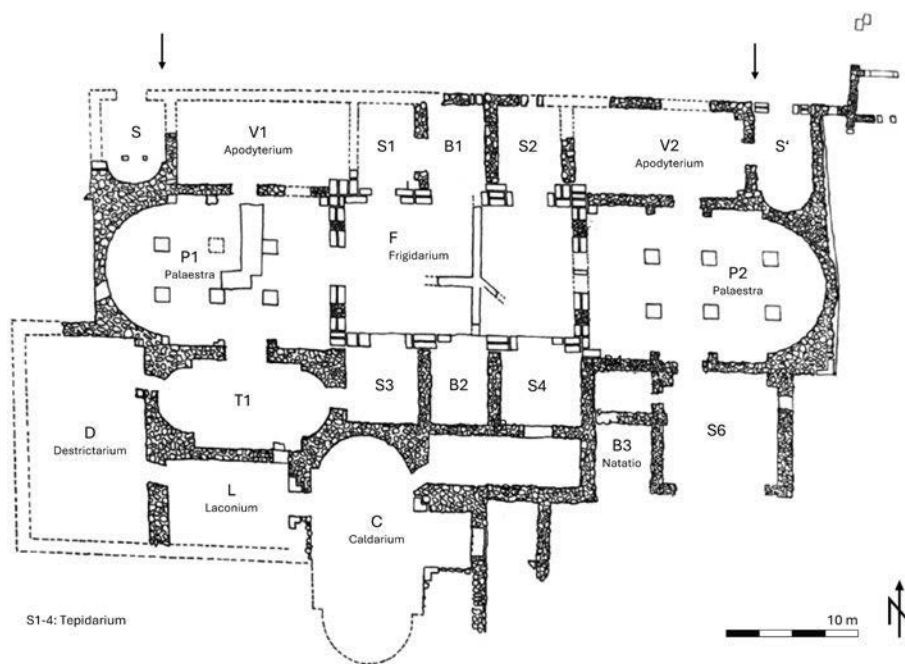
Thignica. Grundriss der Thermenanlage des 3. Jhs.
